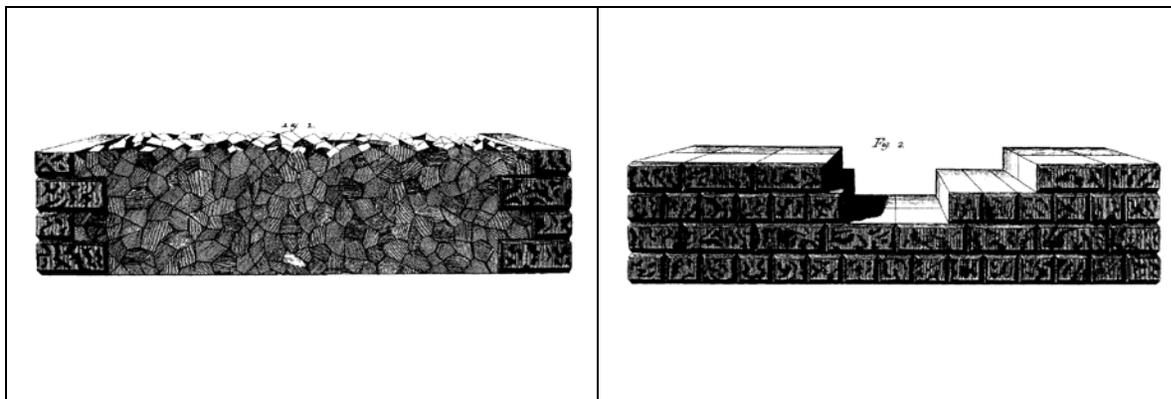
Mampostería incierta de piedras irregulares en sus ángulos y caras con cadena de ángulo de sillares labrados.
